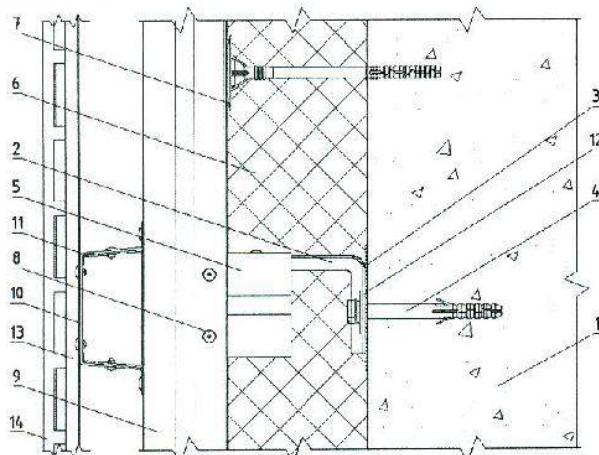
Вертикальный разрез фасадной системы “АЛЬТ-ФАСАД-10”
